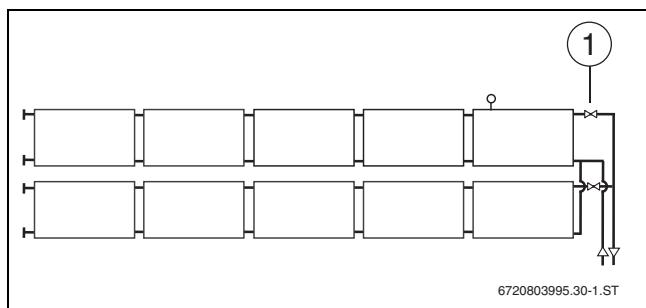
Collegamento sullo stesso lato di un collegamento in parallelo
